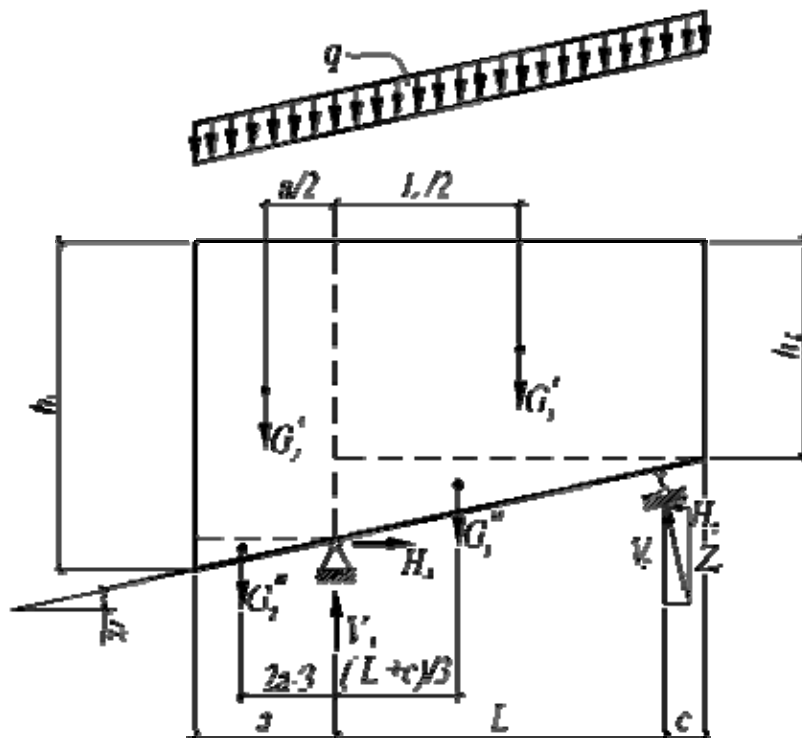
Расчетная схема опалубки наклонного ригеля
